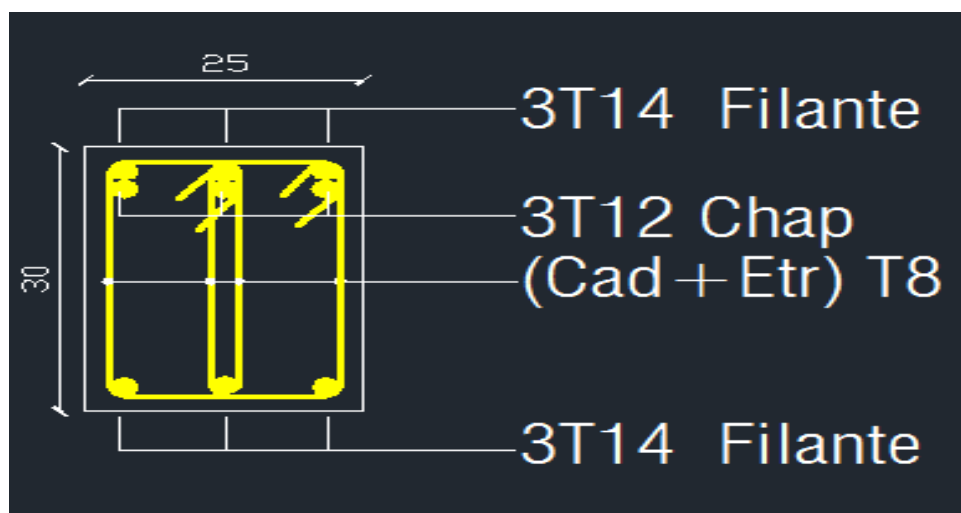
Ferrailage en travée d'une poutre secondaire
